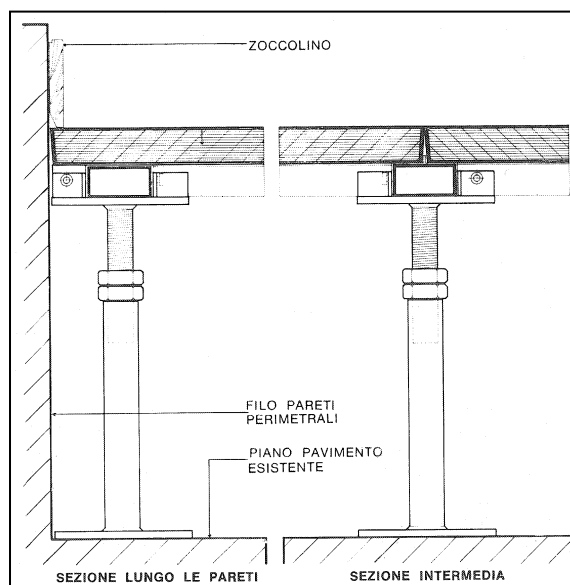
Edificio Tipo B5 – Schema pavimento flottante (riproduzione non in scala)
